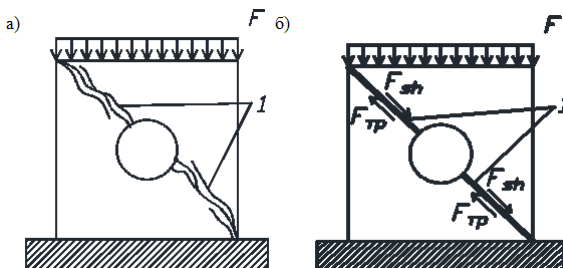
Испытание модели стены с круглым оконным проемом Ø100 мм:
